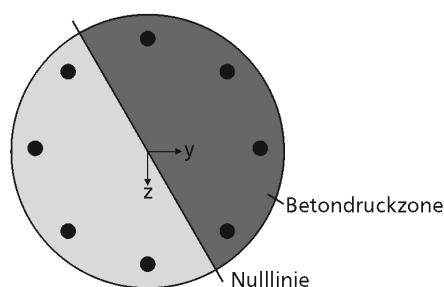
Kreisquerschnitt mit Betondruckzone
